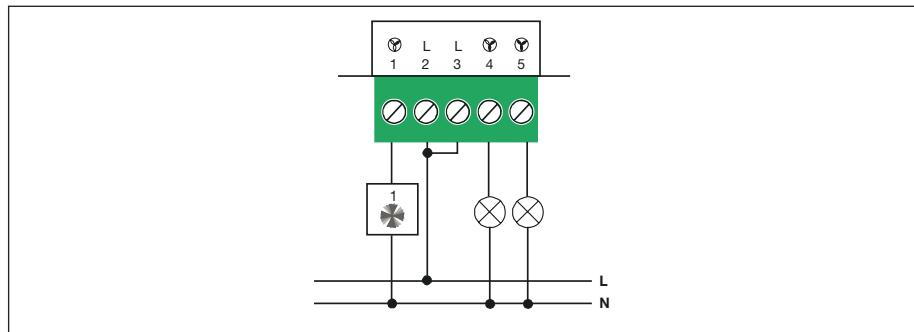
Beleuchtungssteuerung mit dem Fan Coil-Regler
